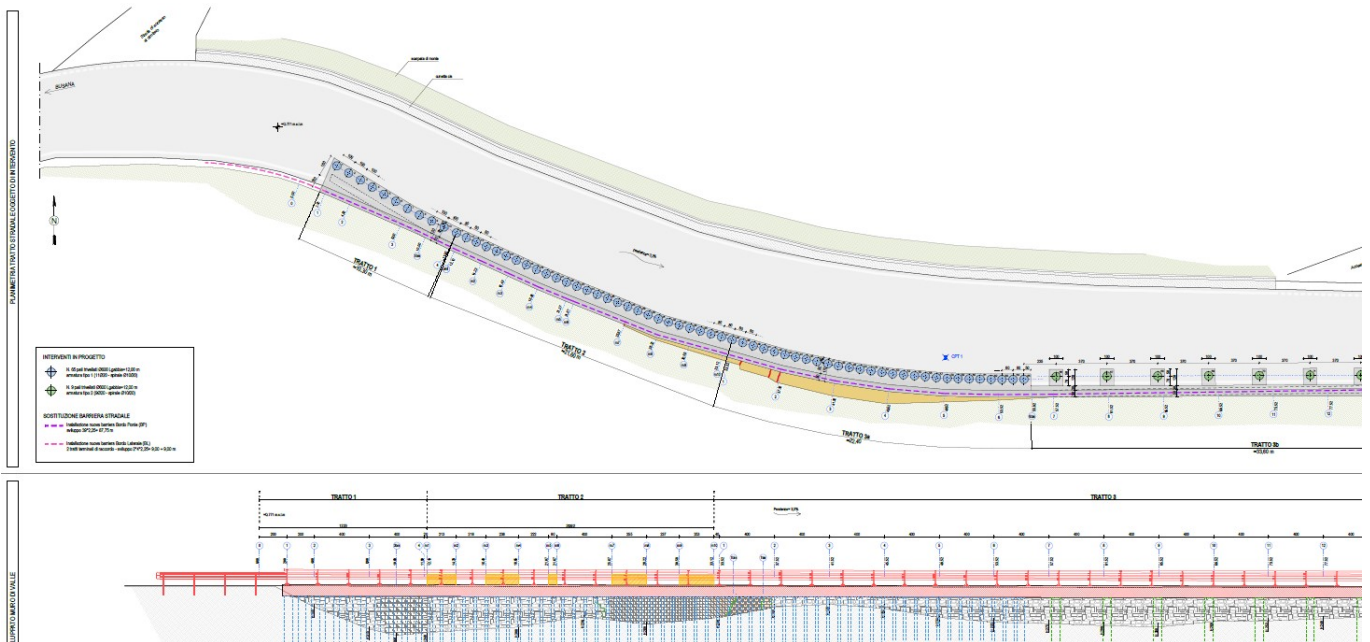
Planimetria e prospetto dello stato di progetto dell'intervento.
